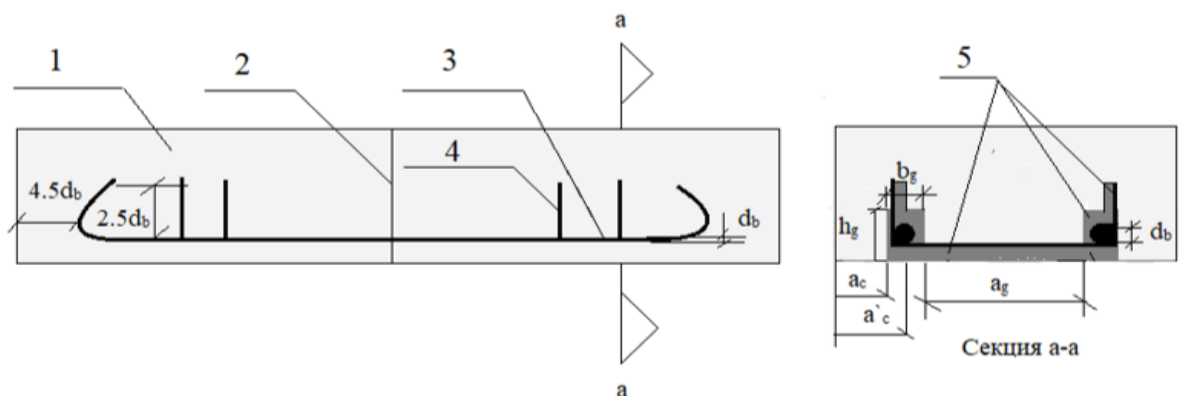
Система армирования поверхности стальным стержнем с анкерровкой арматуры: 1 – газобетонное основание; 2 – вертикальный шов; 3 – продольный стержень (A400 Ø10 мм); 4 – вертикальная арматура (A400 Ø8 мм); 5 – штробы
